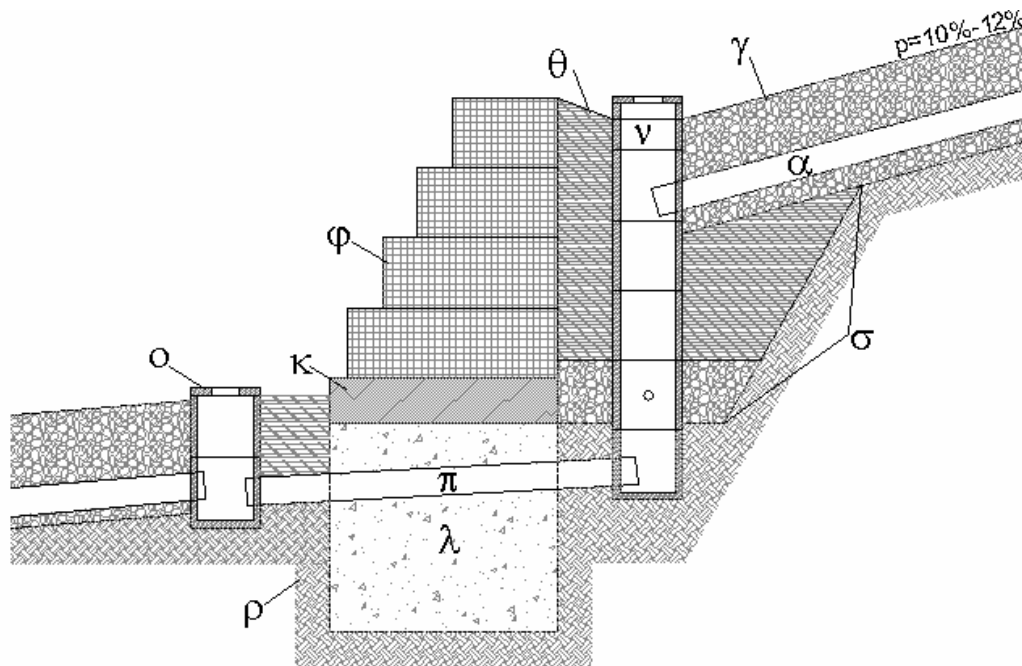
Sezione 1-1' di Fig. 2 raffigurante una briglia in gabbioni fondata su trave provvista di setti, completa di opere di raccolta e smaltimento acque. Legenda: φ) gabbioni; κ) trave di fondazione; λ) setto di fondazione; γ) drenaggio; ν) pozzetto di monte; ο) pozzetto di valle; π) condotta di scarico cieca a collegamento dei pozzetti; θ) terreno di riempimento compatto; ρ) substrato roccioso; σ) sezione di sbancamento; γ) collettore principale; α) collettore di scarico cieco
